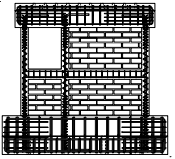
試験体の形状・寸法・配筋詳細 (試験体 CMW0-06)
